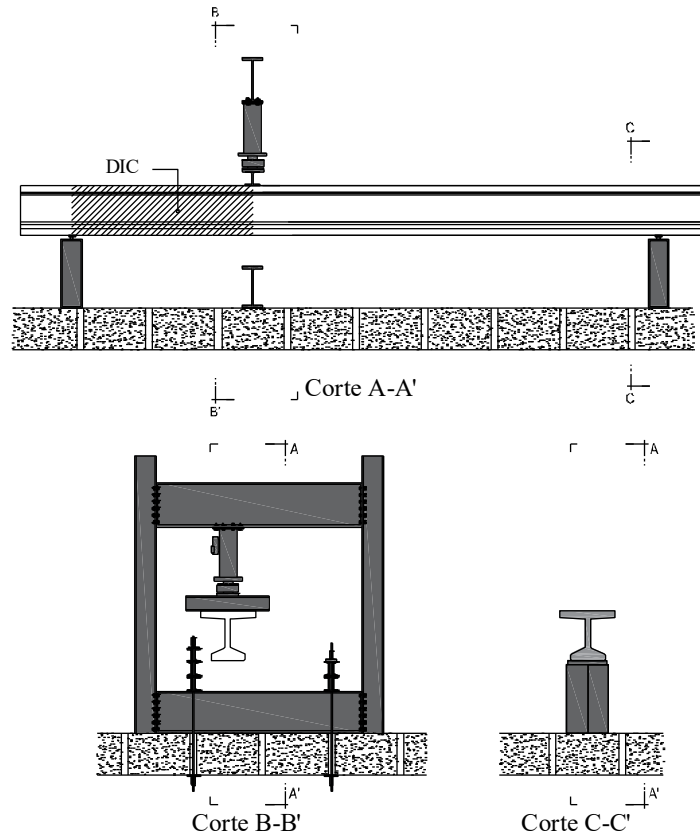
Arranjo experimental para ensaios de corte em vigas simplesmente apoiadas
